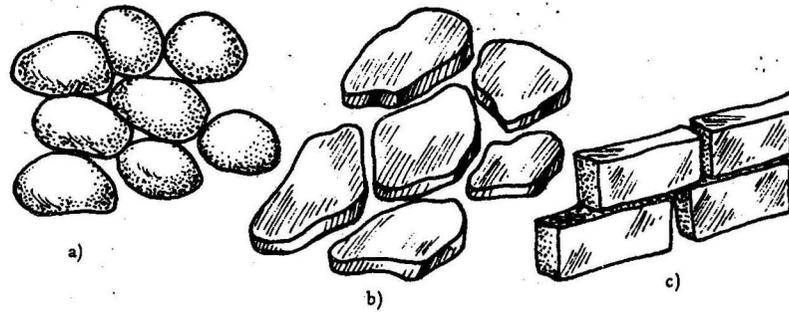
Distintas piedras naturales de construcción: a) mampuestos; b) lajas; c) sillarejos
